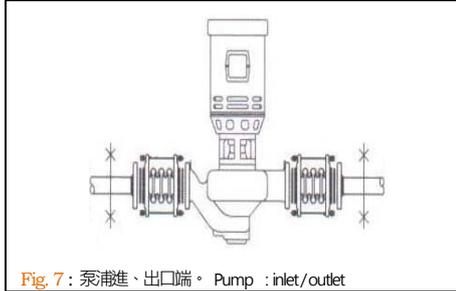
泵浦進、出口端。 Pump : inlet/outlet
